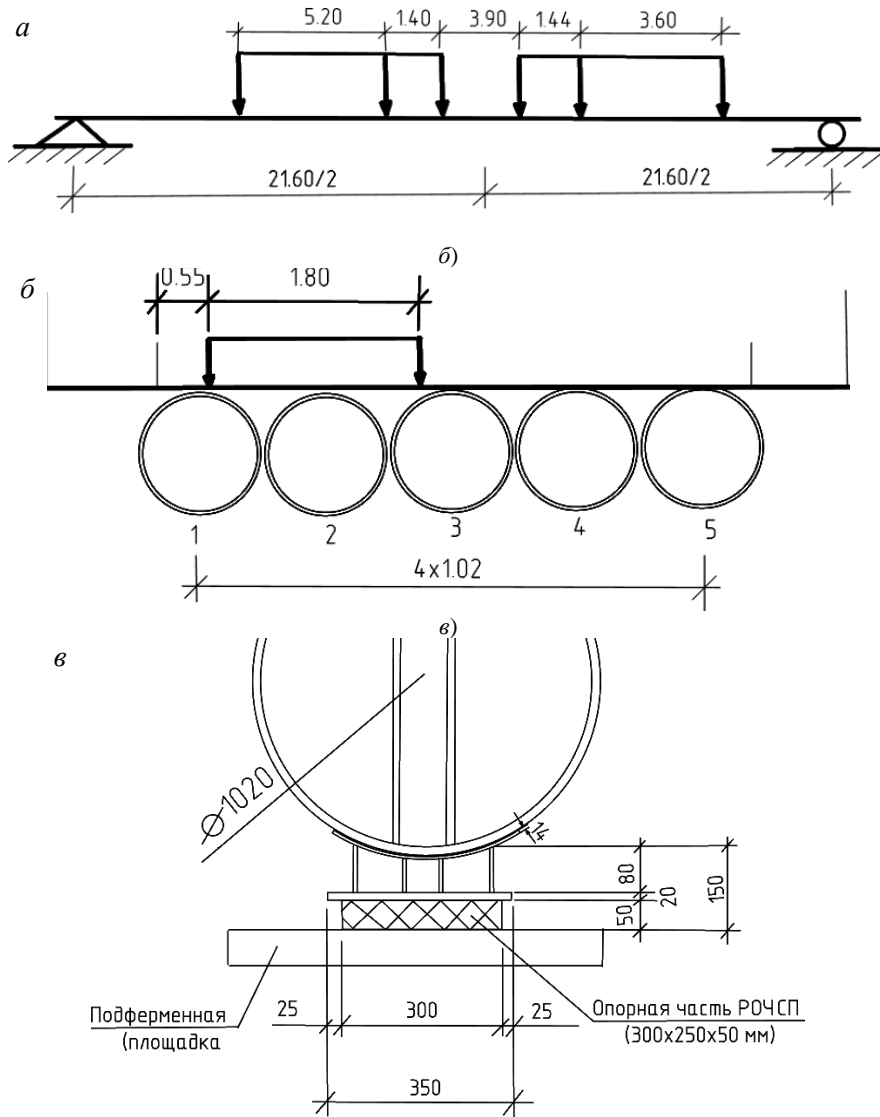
Нагрузочные и конструктивные решения при исследовании клавишного эффекта: а – схема продольного нагружения; б – схема поперечного нагружения пролетного строения испытательной нагрузкой; в – конструкция узла опорного сечения для балок трубчатого сечения
